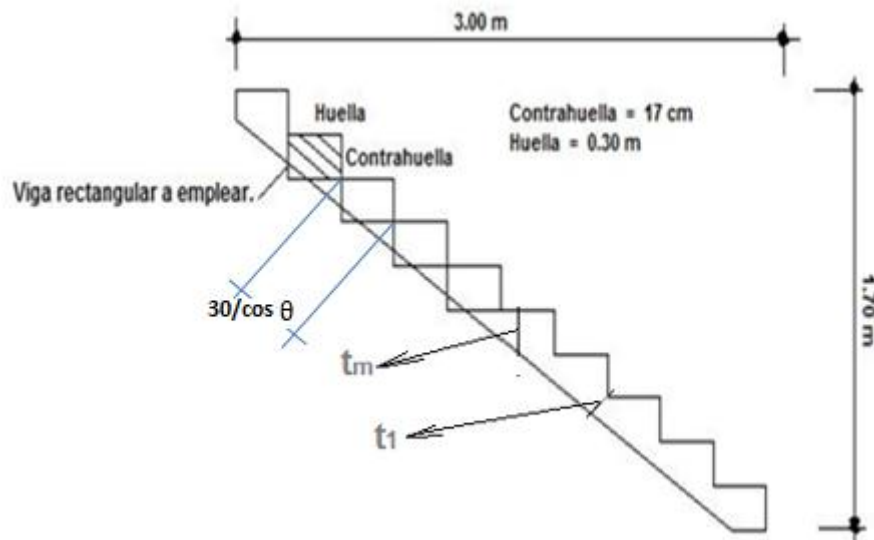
Sección transversal de viga a emplear en el cálculo.
